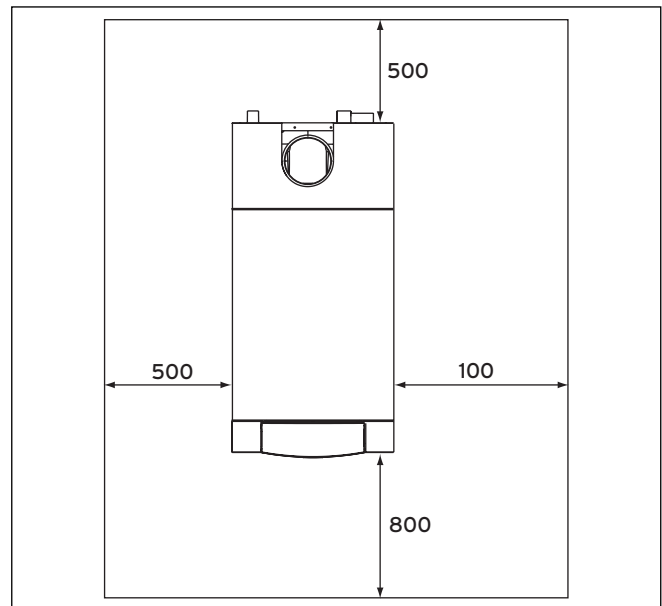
Distanțe recomandate la asamblare (dimensiuni în mm)
